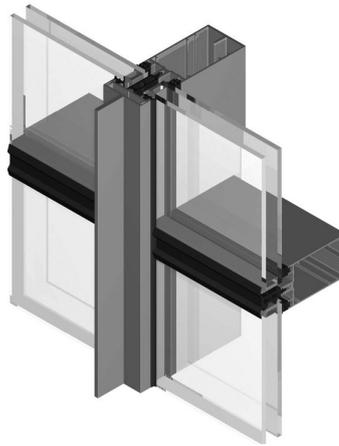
Muro cortina stick con tapetas verticales y silicona estructural horizontal.
